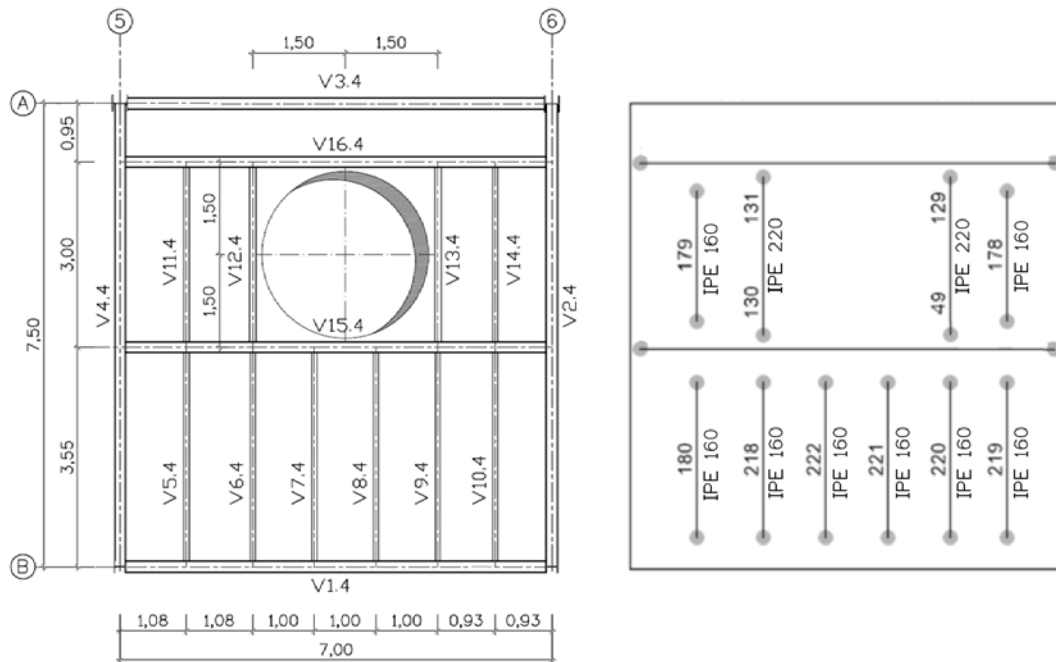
Planta com a identificação das Vigas Interiores do Piso 4
